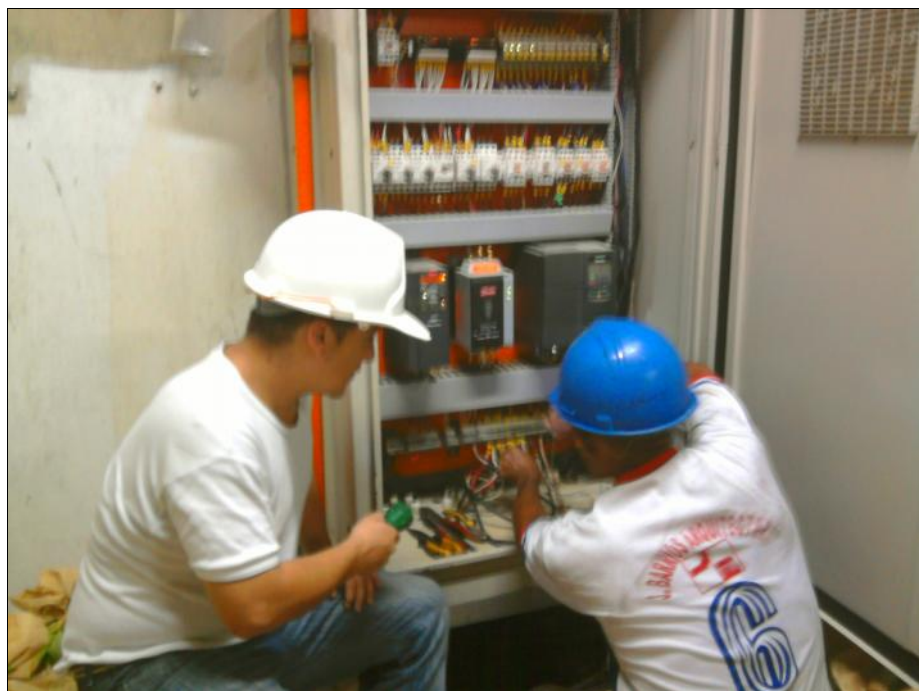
Vista Intervención Tablero Área Blanca (P.E)
